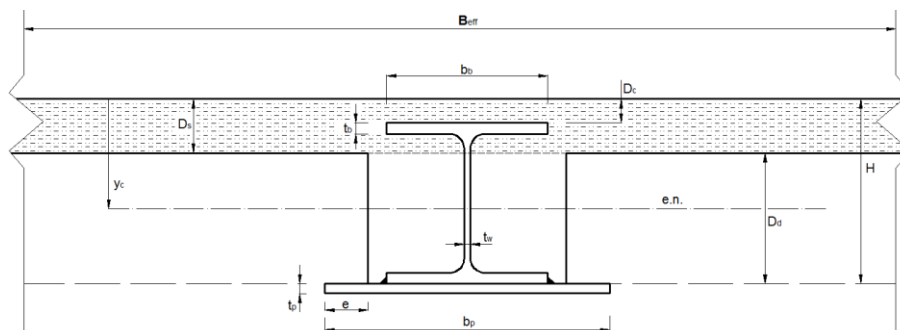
Secção de uma viga mista do tipo *Slimflor Beam*.
